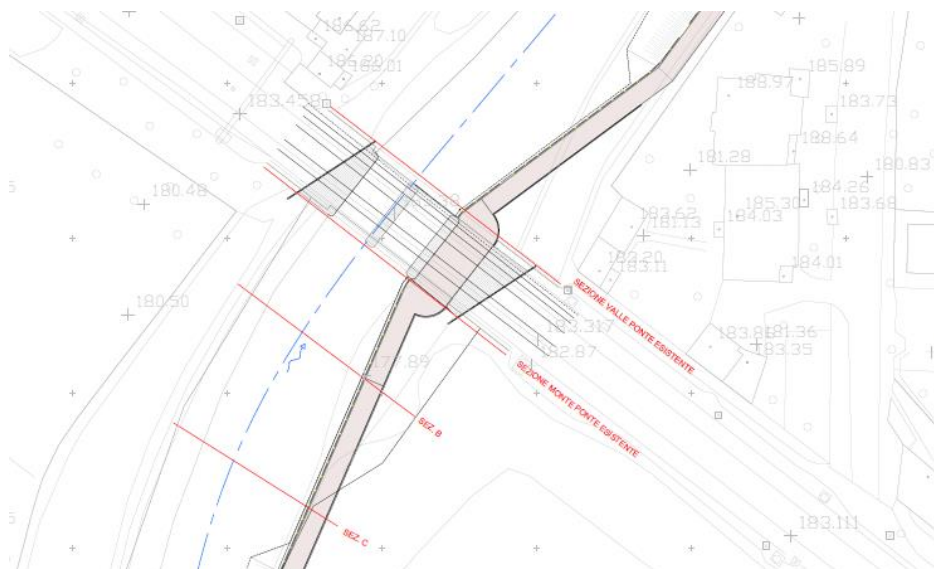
Stralcio planimetrico stato di fatto attraversamento ferroviario Canale Villoresi
